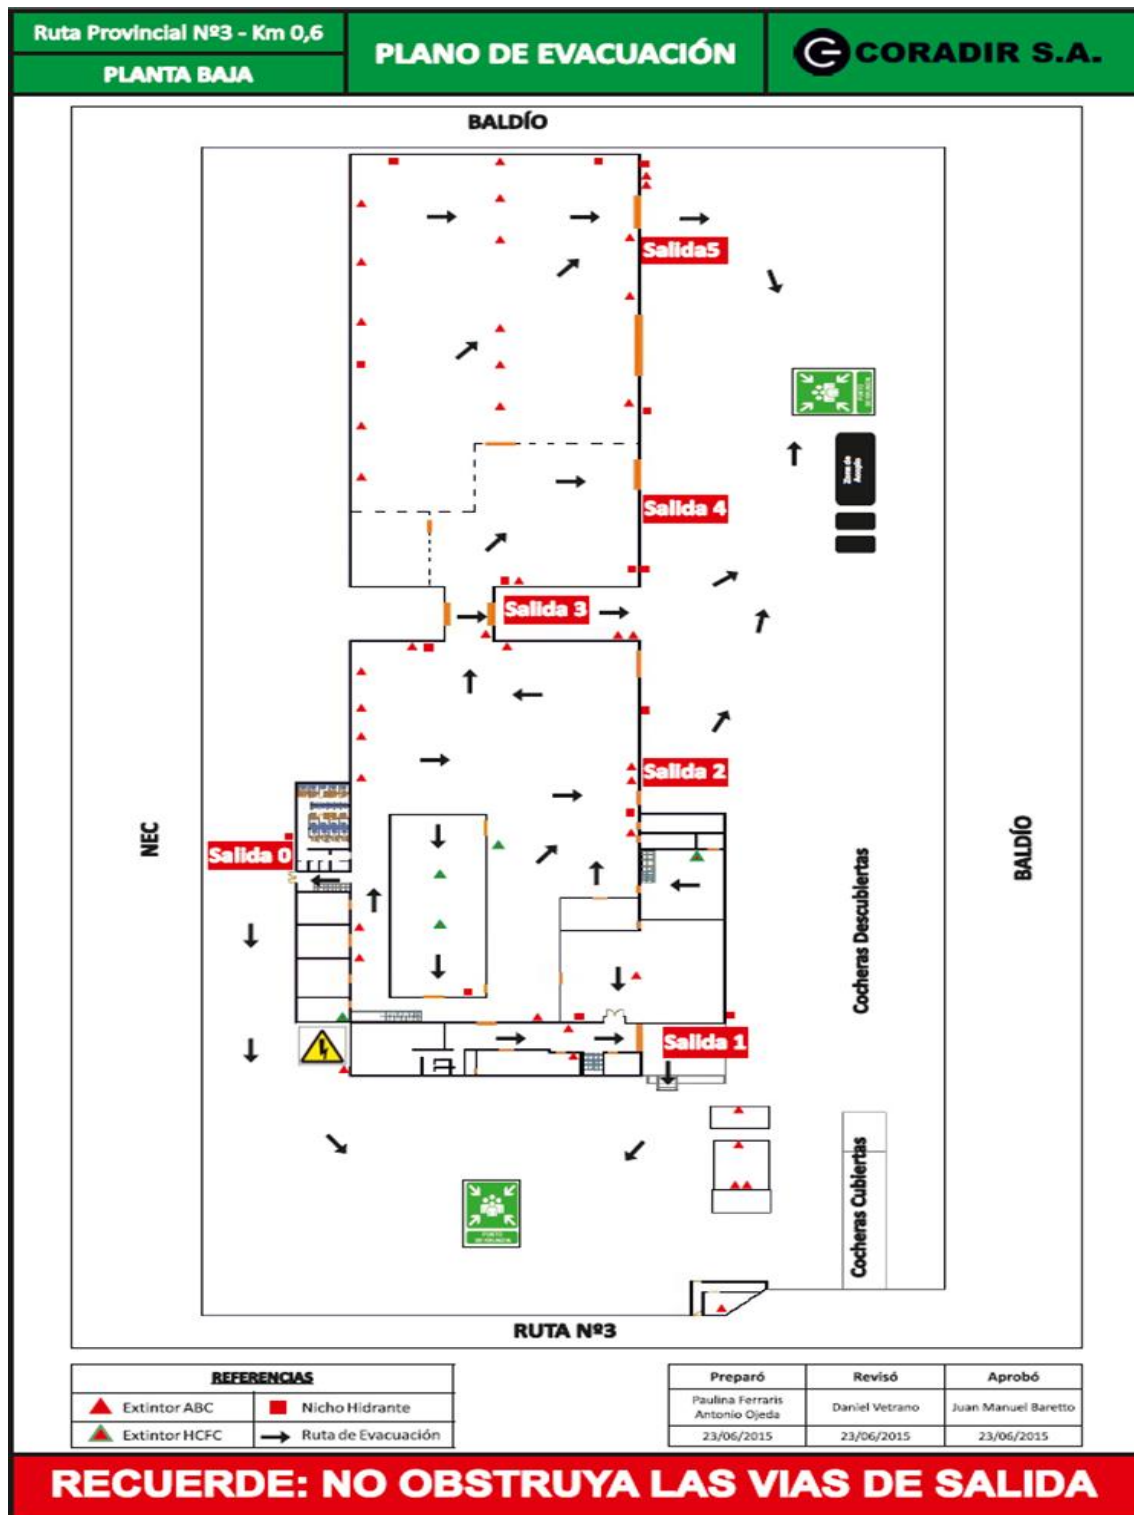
Planos de evacuación, extintores y nichos hidrantes planta baja.
